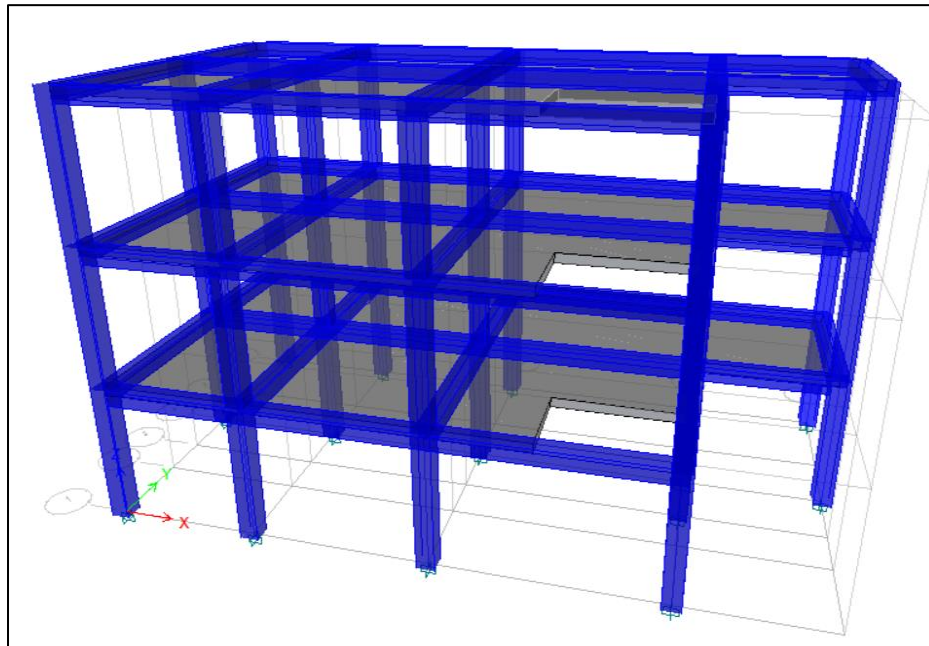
Vistas en planta - Edificación de 2 niveles con cubierta en placa
